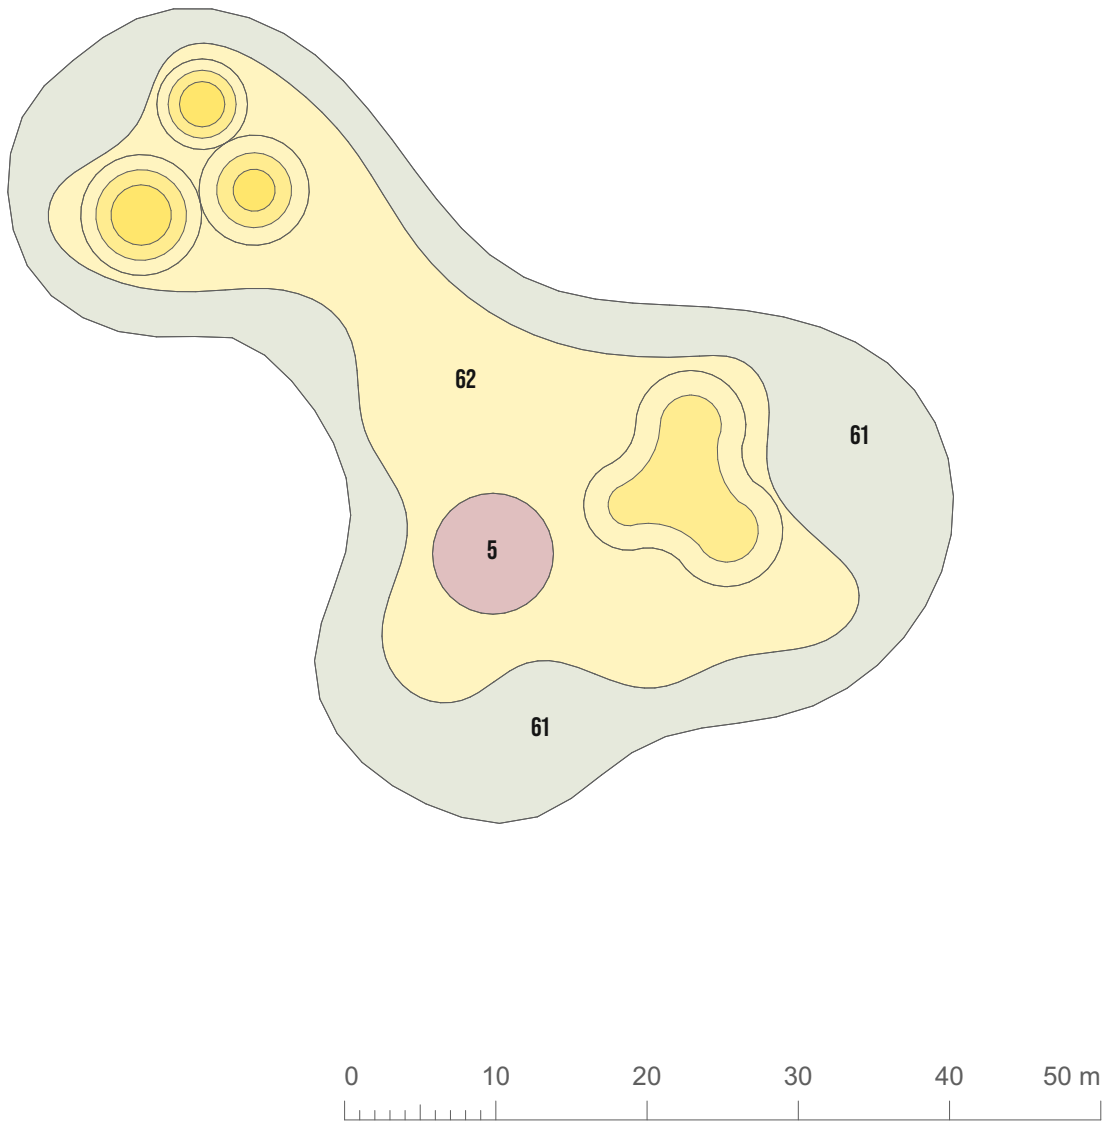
Raumprogramm, Grundriss, Dachdraufsicht
